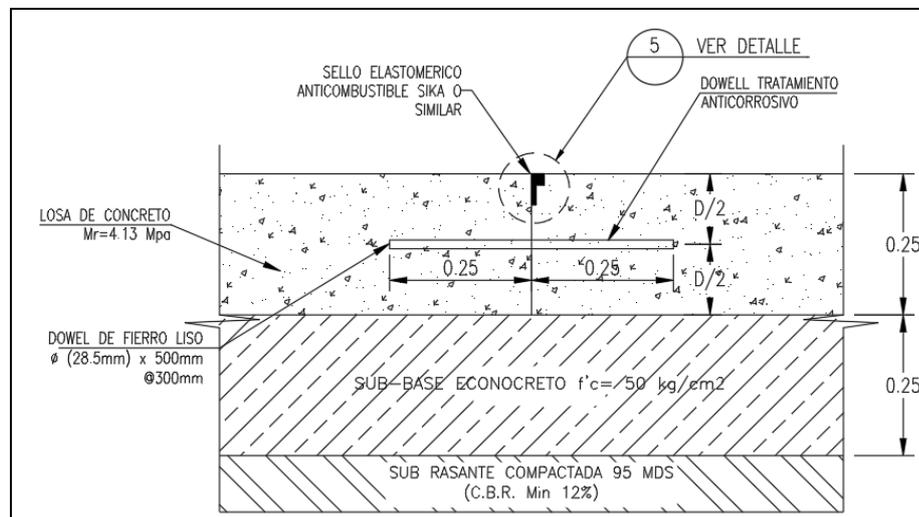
Sección Típica de Pavimento ingreso a Aviación Naval.
